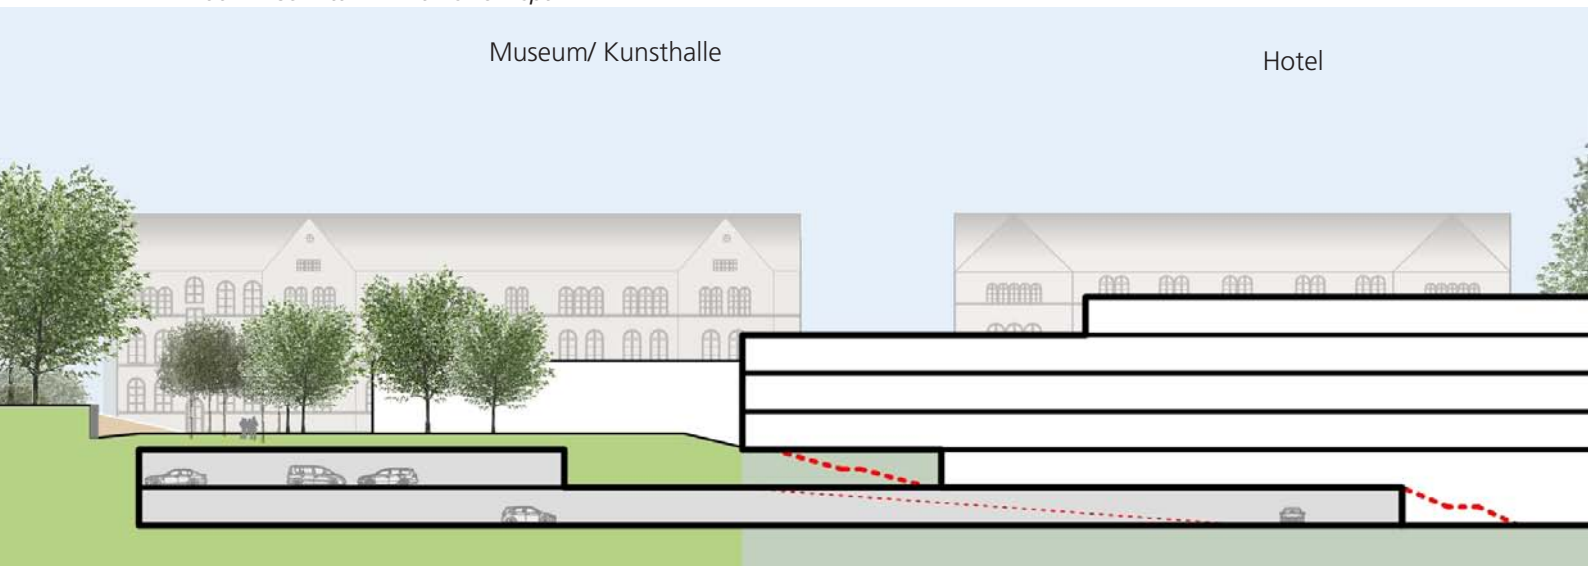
Verbindungen des Quartiers mit den Wallanlagen
